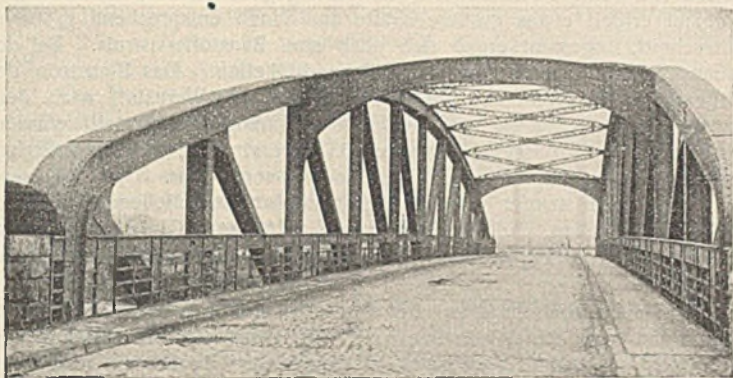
Straßenbrücke mit abgerundeter Ecke.
